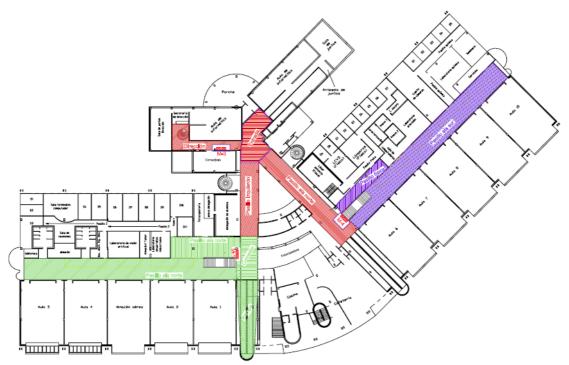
Vista en planta de los espacios docentes en la actual ETSII (Edificio I – Planta Baja)
